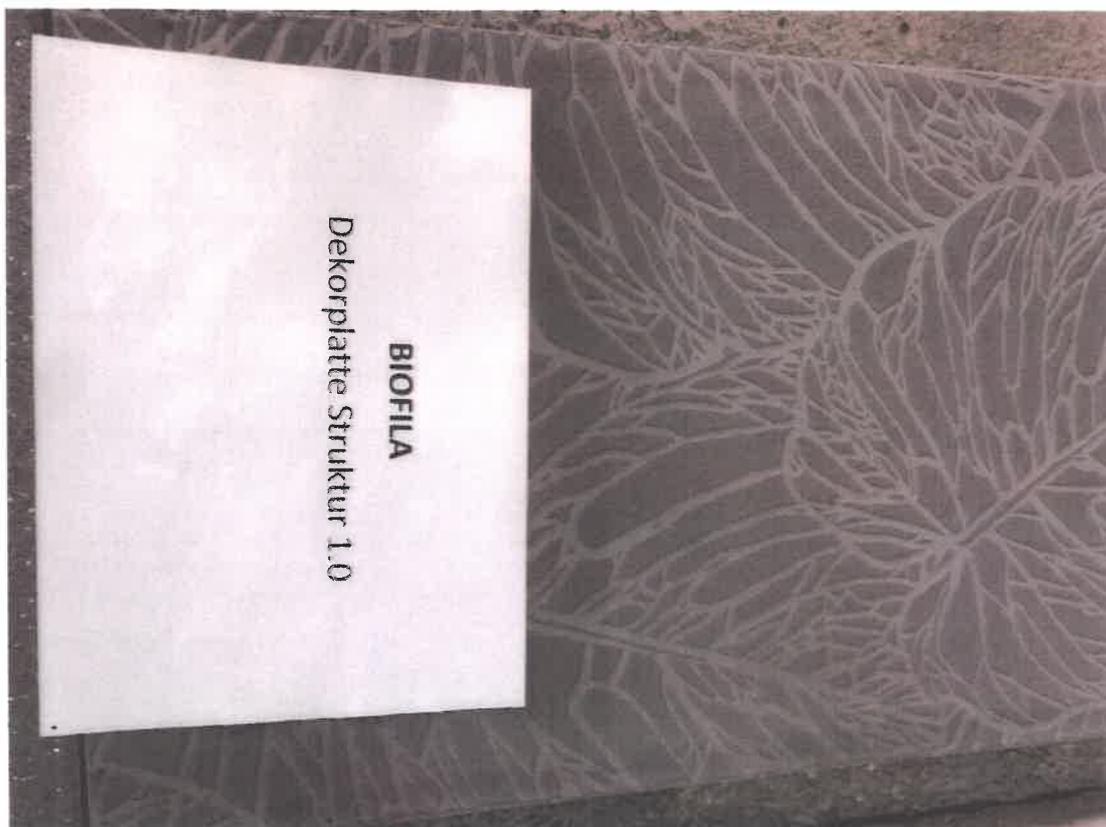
Die zu prüfende Betonoberfläche BIOFILA, Dekor 2, Struktur 1,0.
